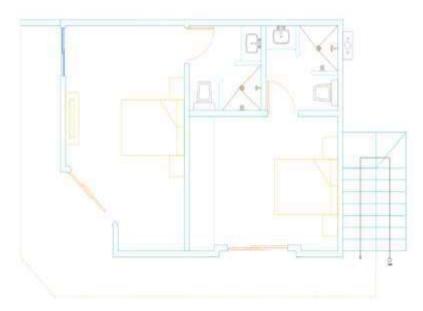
Planta Arquitectónico P/1 Fuente: Elaborado por el autor
